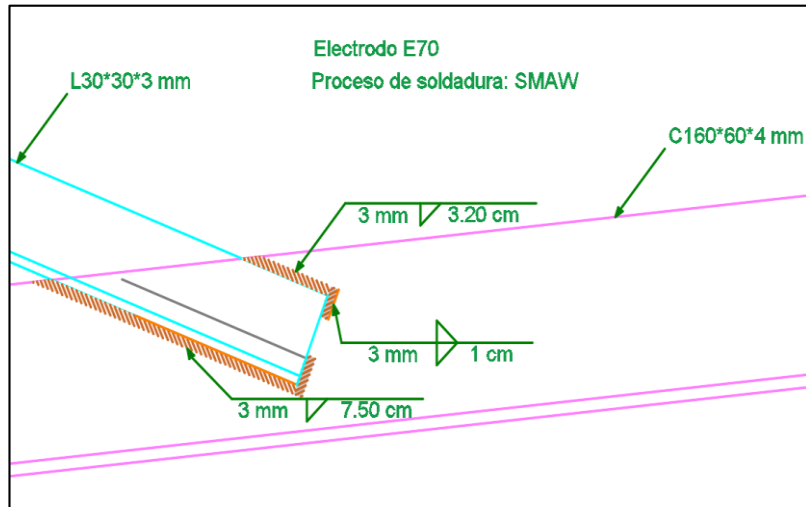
Detallamiento de Soldadura L30*30*3 mm.
